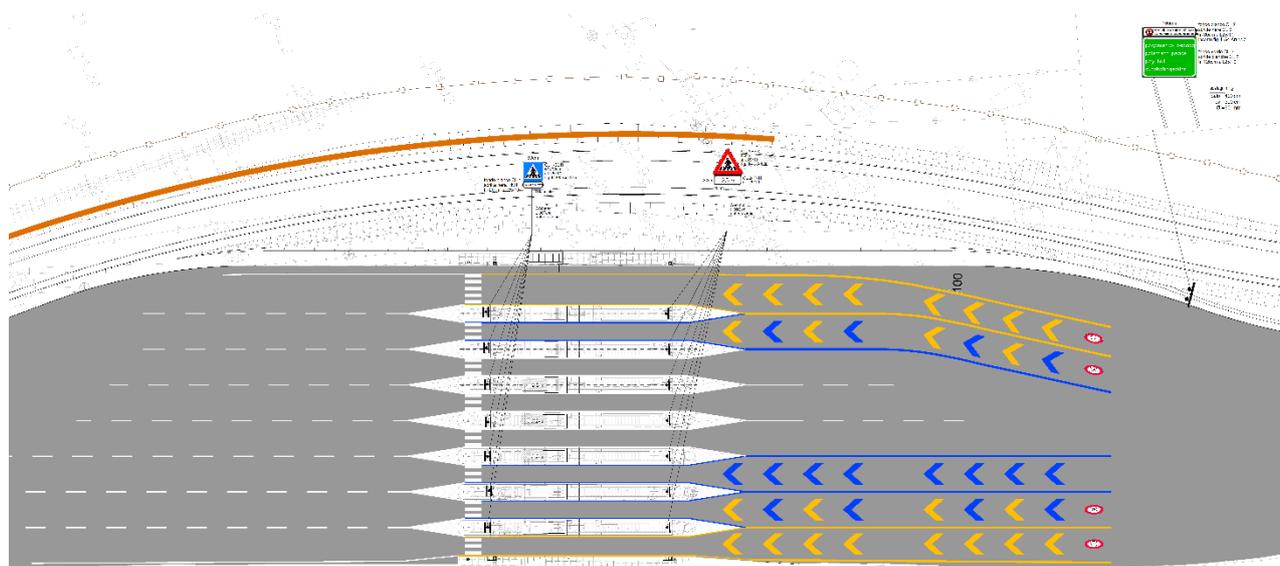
Pianta dei varchi di progetto in uscita A13
